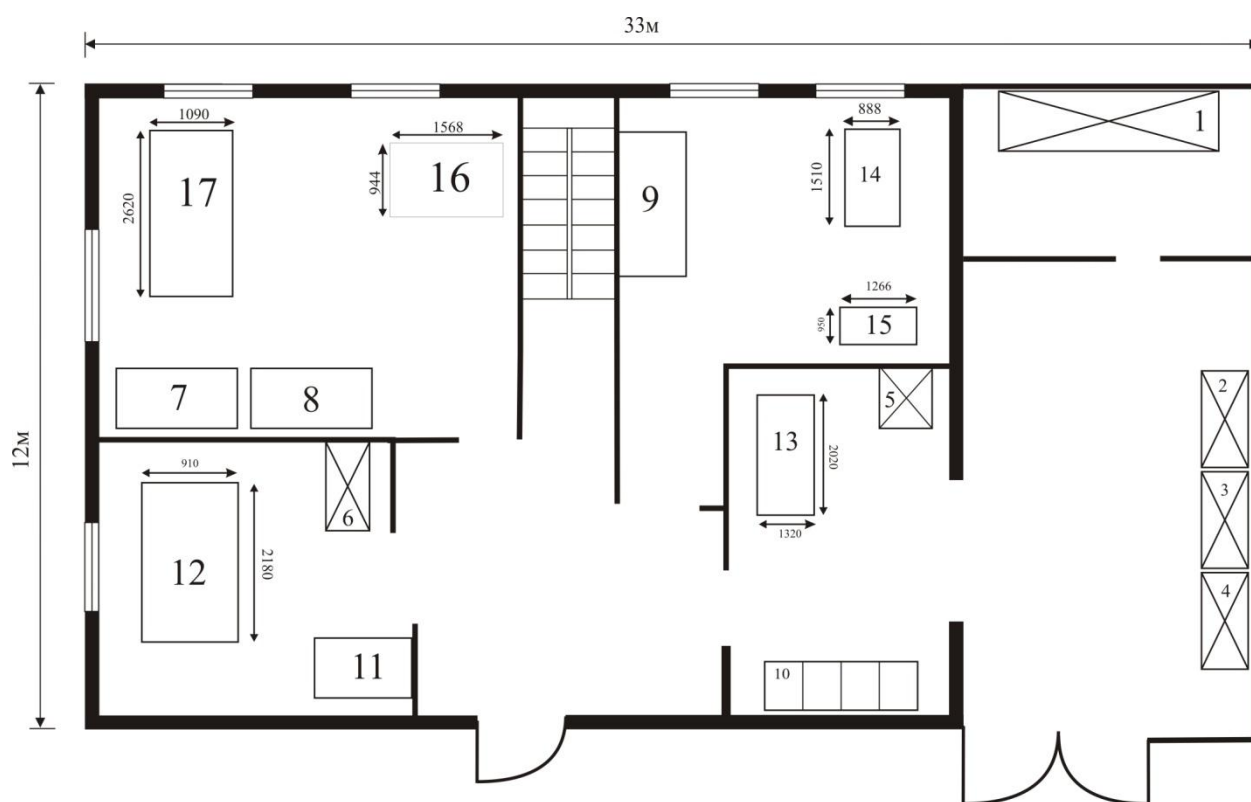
Планировка производственных помещений, 1 этаж
